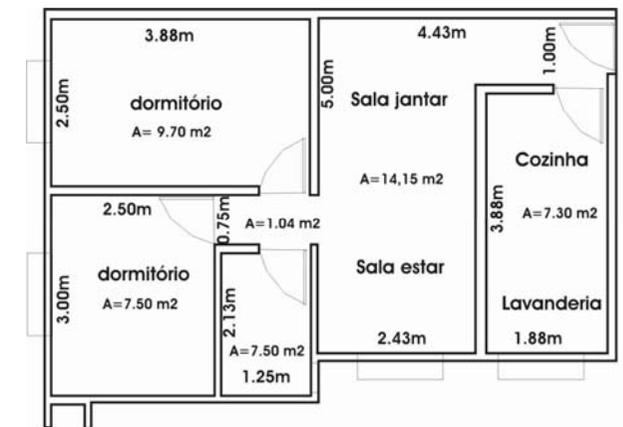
Planta da unidade habitacional do Conj. Cazuzu.
